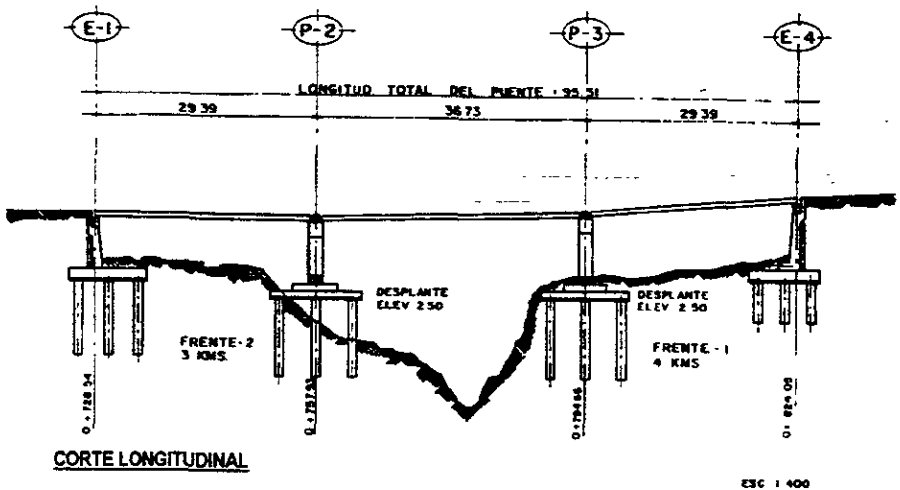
Perfil longitudinal del puente Punta Diamante.
